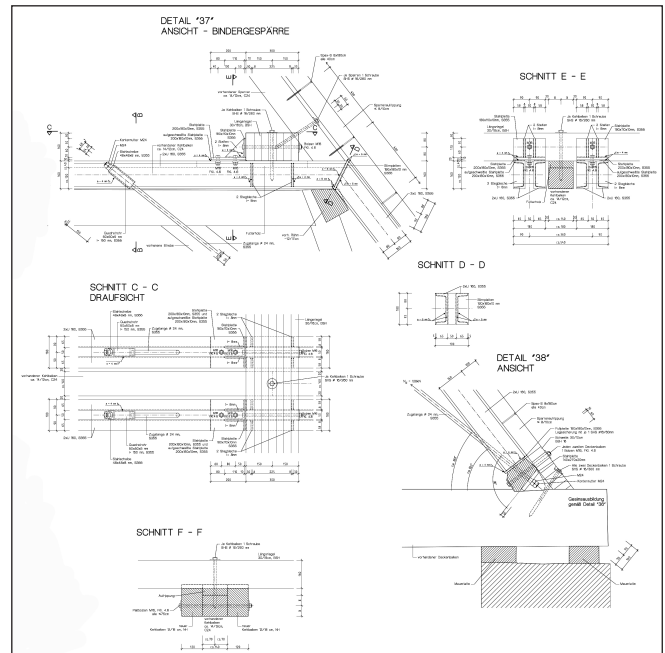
Detailplan der Verstärkungsstruktur / Plan M40.
